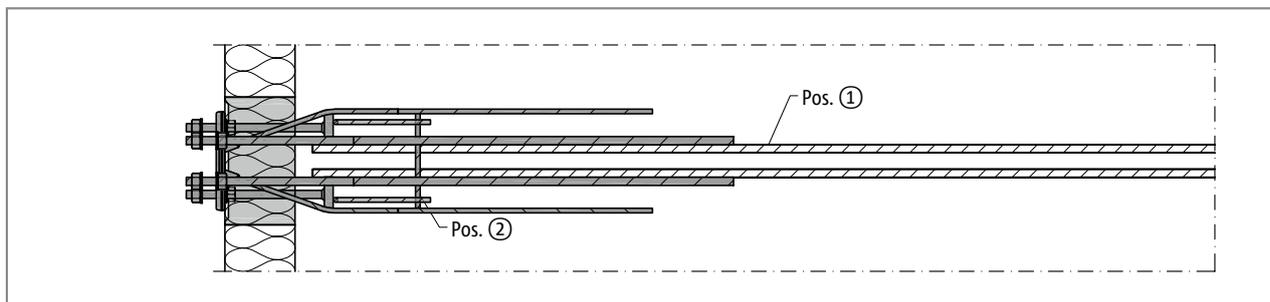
Schöck Isokorb® XT Typ SK-M1: Bauseitige Bewehrung, Grundriss
